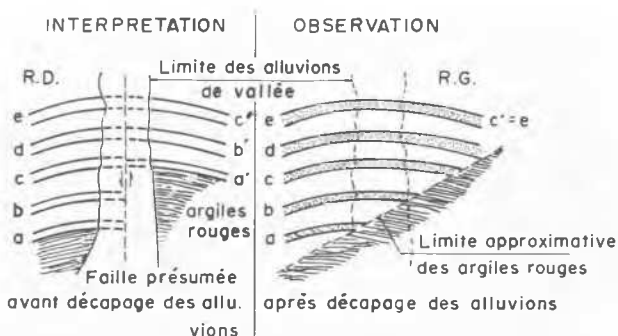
Vue en plan schématique de la disposition des couches sous le pied aval du barrage
